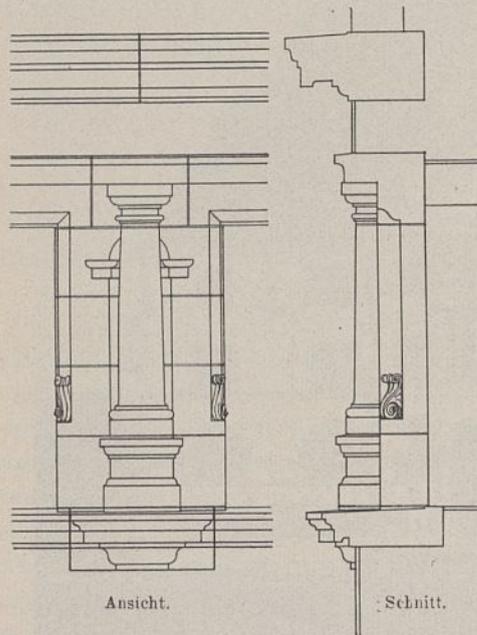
Hauptgesims und Fensterpilaster im Dachgeschoß. 1:33 $\frac{1}{2}$.
